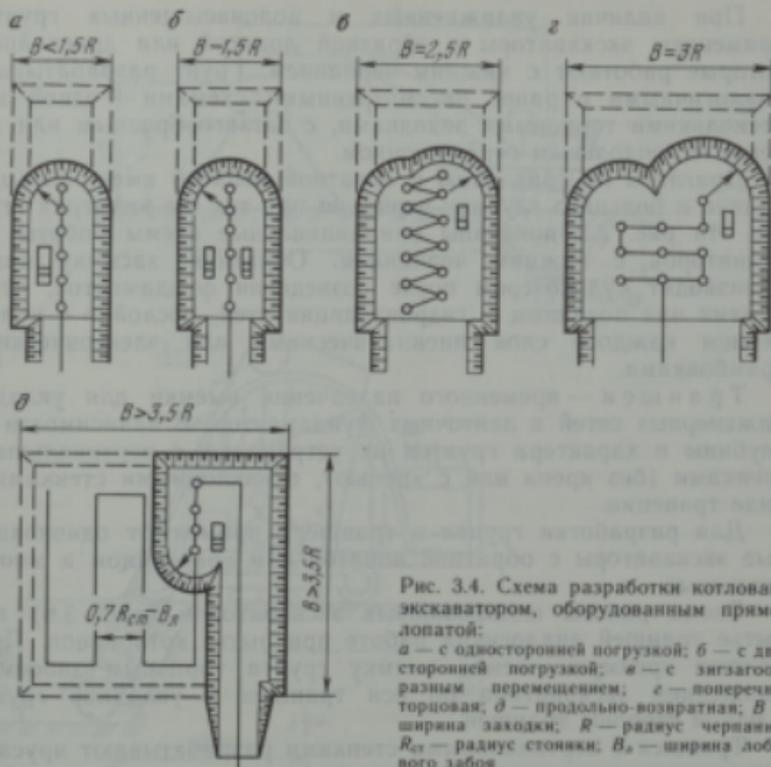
Схема разработки котлована экскаватором, оборудованным прямой лопатой:
